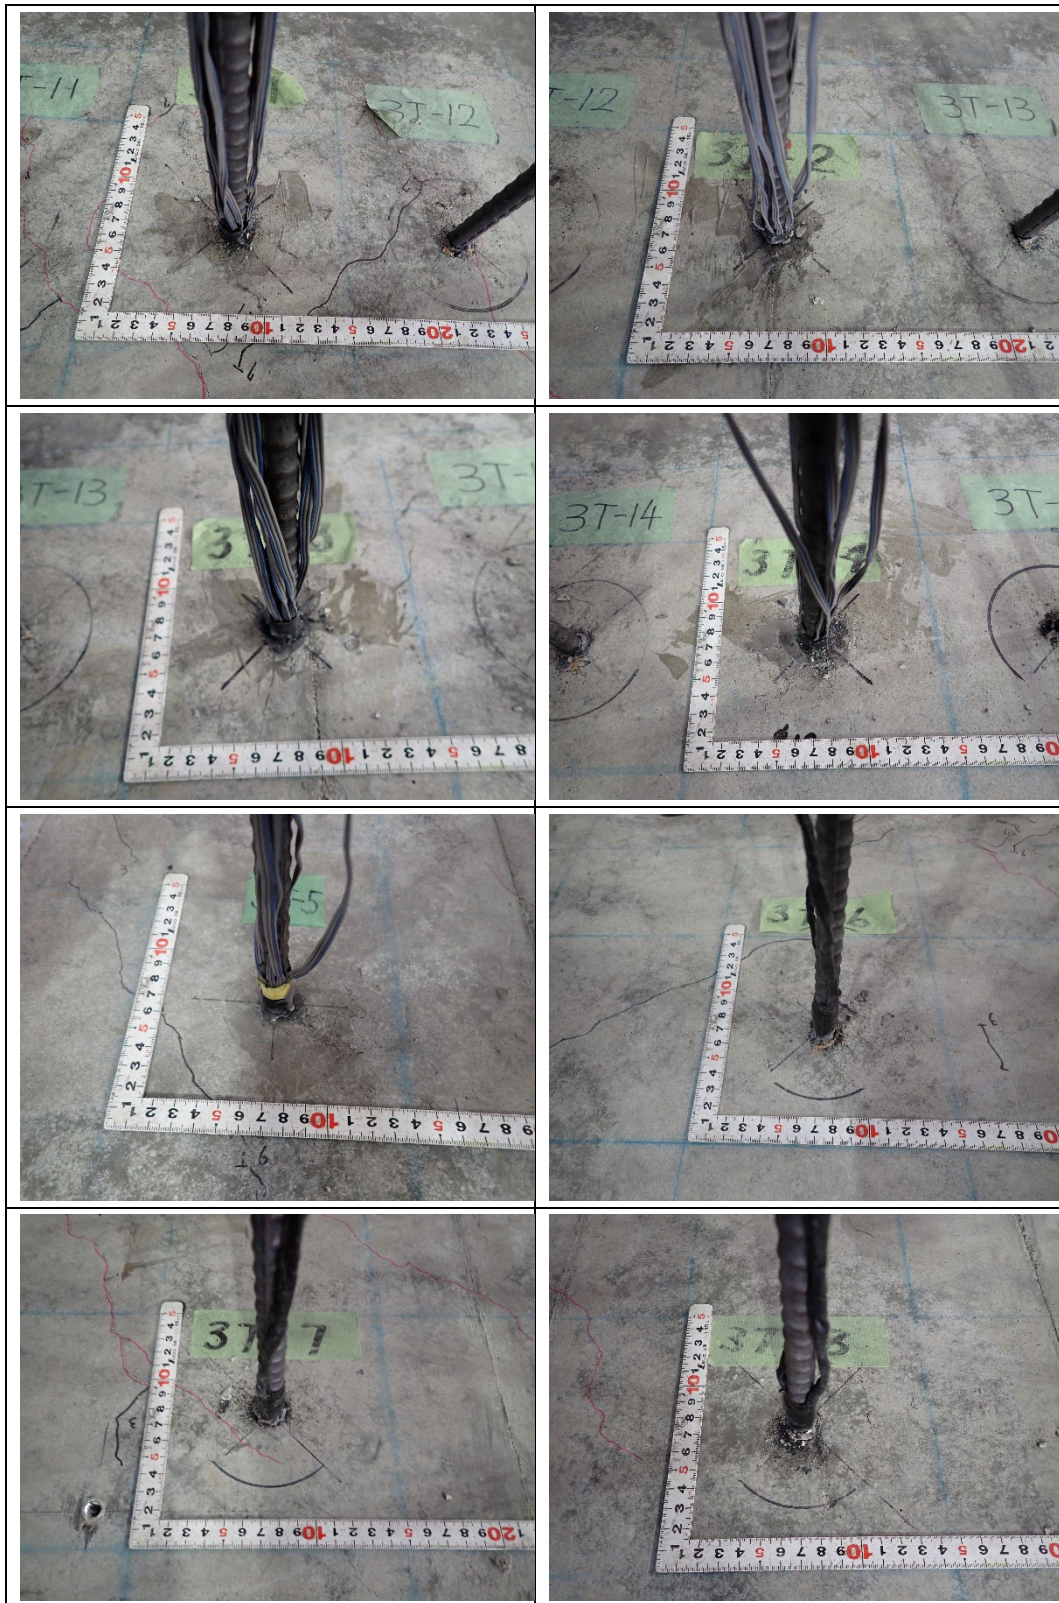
あと施工アンカー単体実験破壊状況 (3T-1～3T-8)
